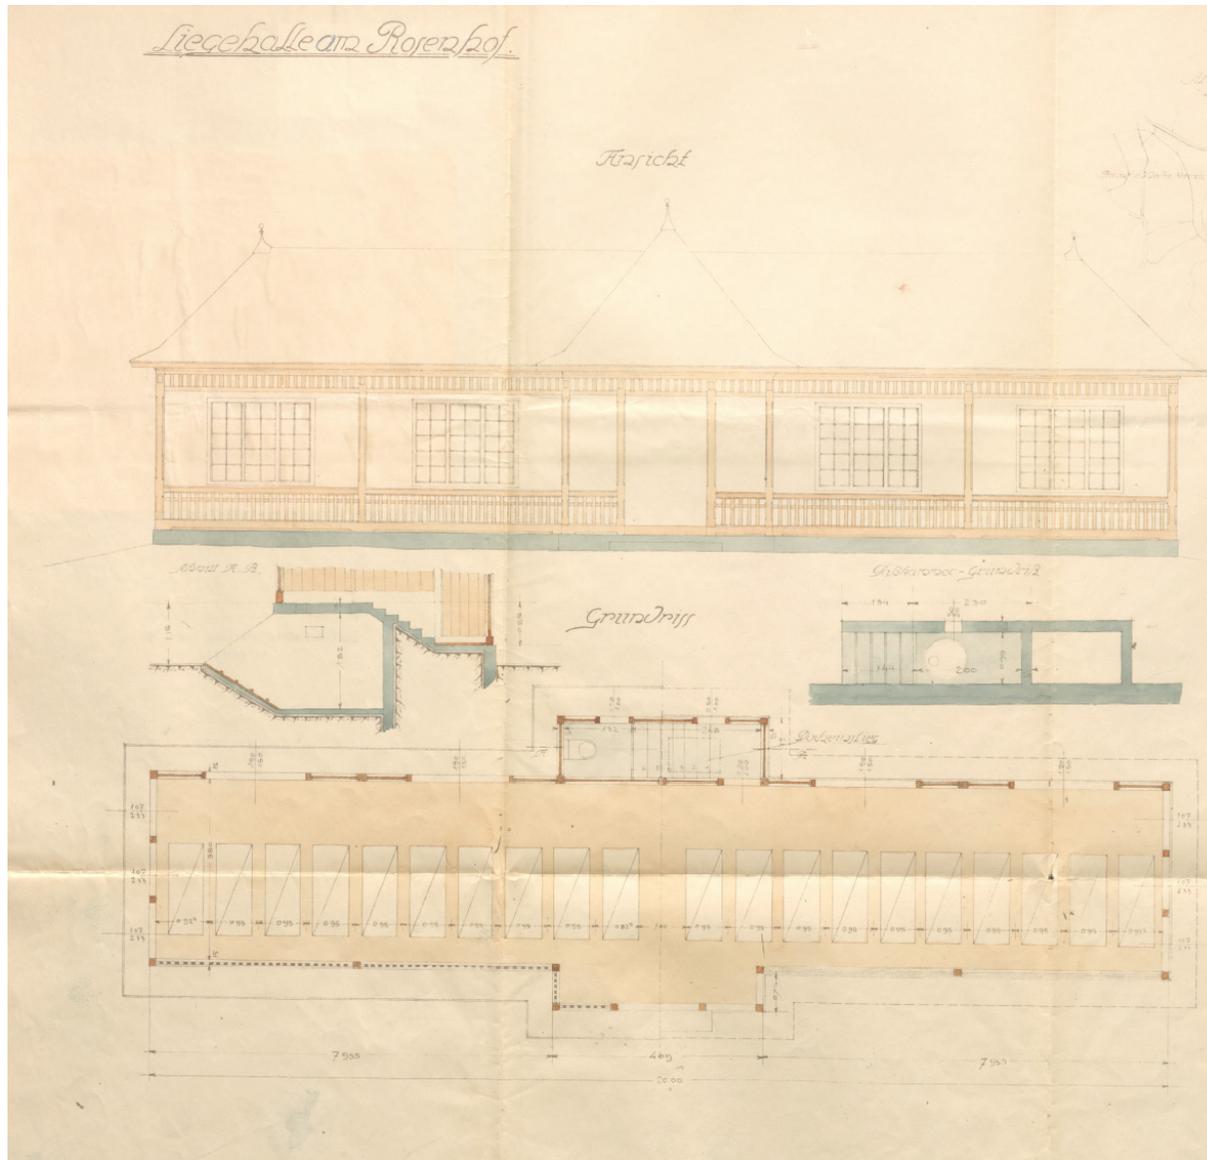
Grundriss und Frontansicht der Liegehalle (J.G. Wolf Bau- und Aktieng)
